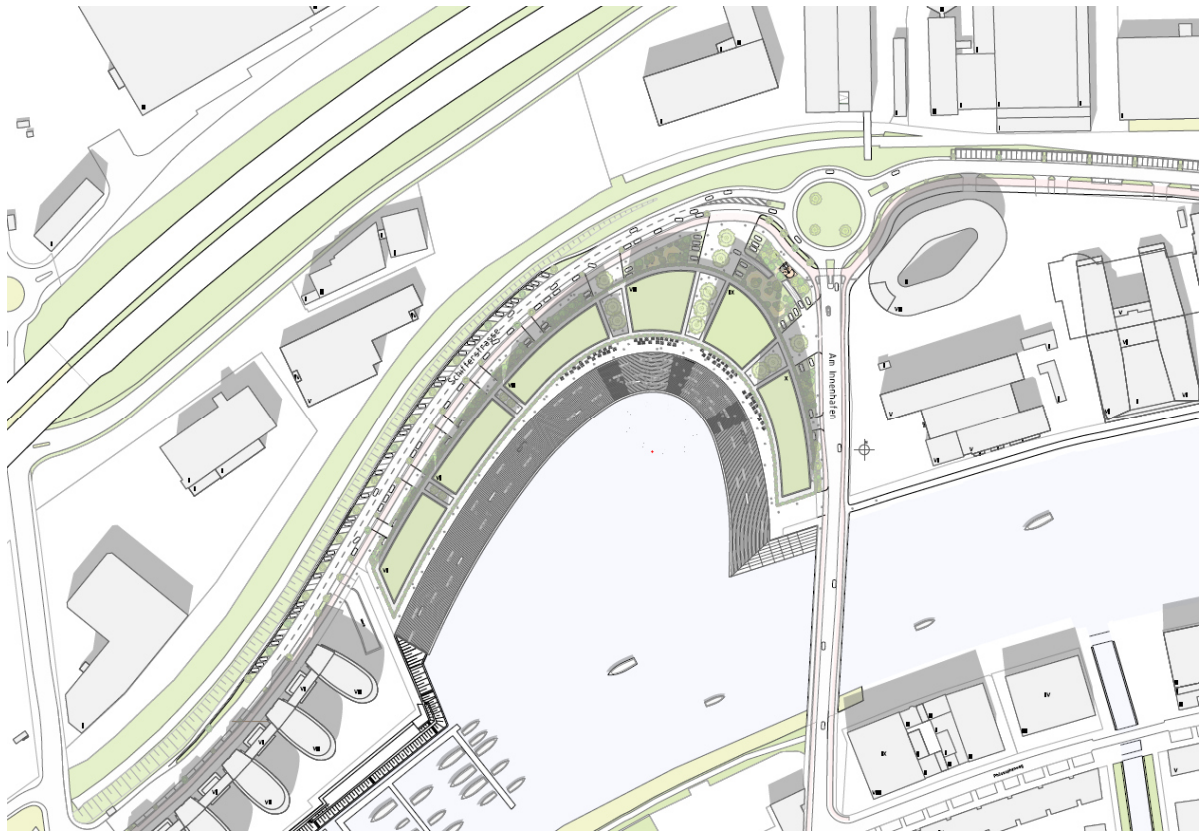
Lageplans des Vorhabens (ohne Maßstab), Stand Februar 2025
